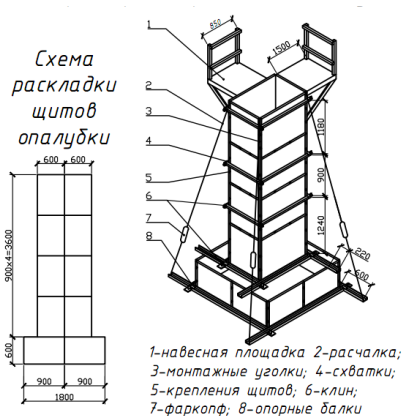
Конструкция опалубки и монтажных приспособлений
